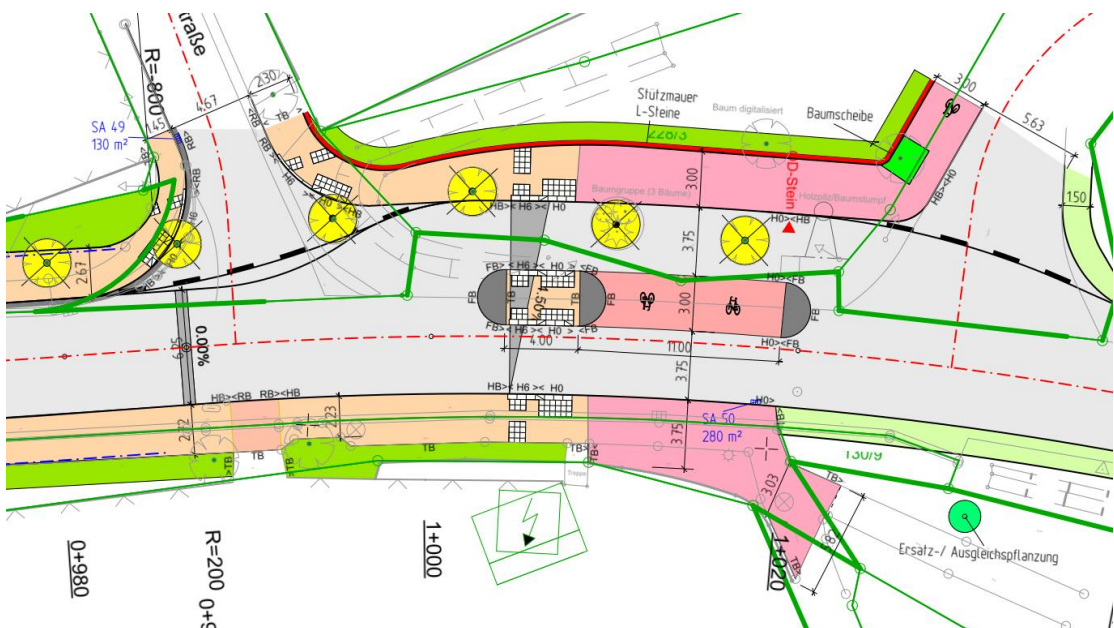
Planausschnitt Querungsstelle Station 1+020 m
